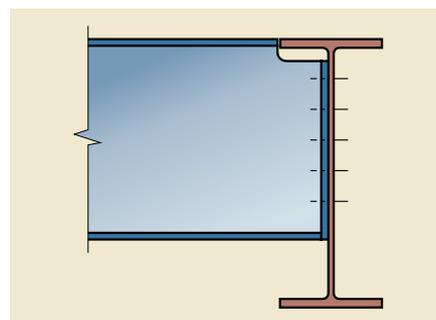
Unión viga-viga con rebaje en viga secundaria
